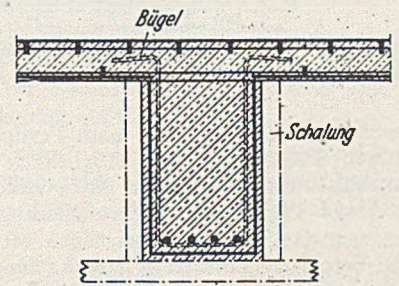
I-Trägerrost mit Betonfüllung in Verbindung mit Stahlbetonunterzug.
